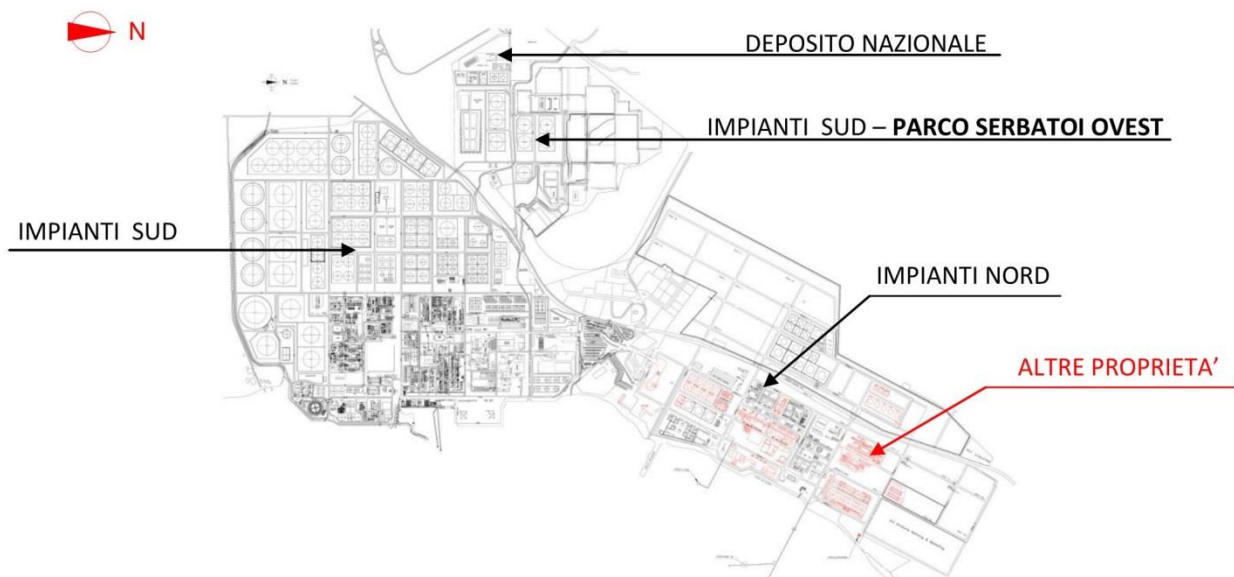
Planimetria generale dello Stabilimento Sarlux – Area Impianti SUD e NORD
